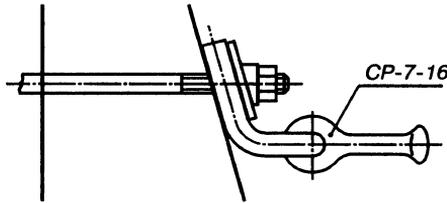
Арматура для крепления подвесных изоляторов верхней фазы ВЛ 6–10кВ
